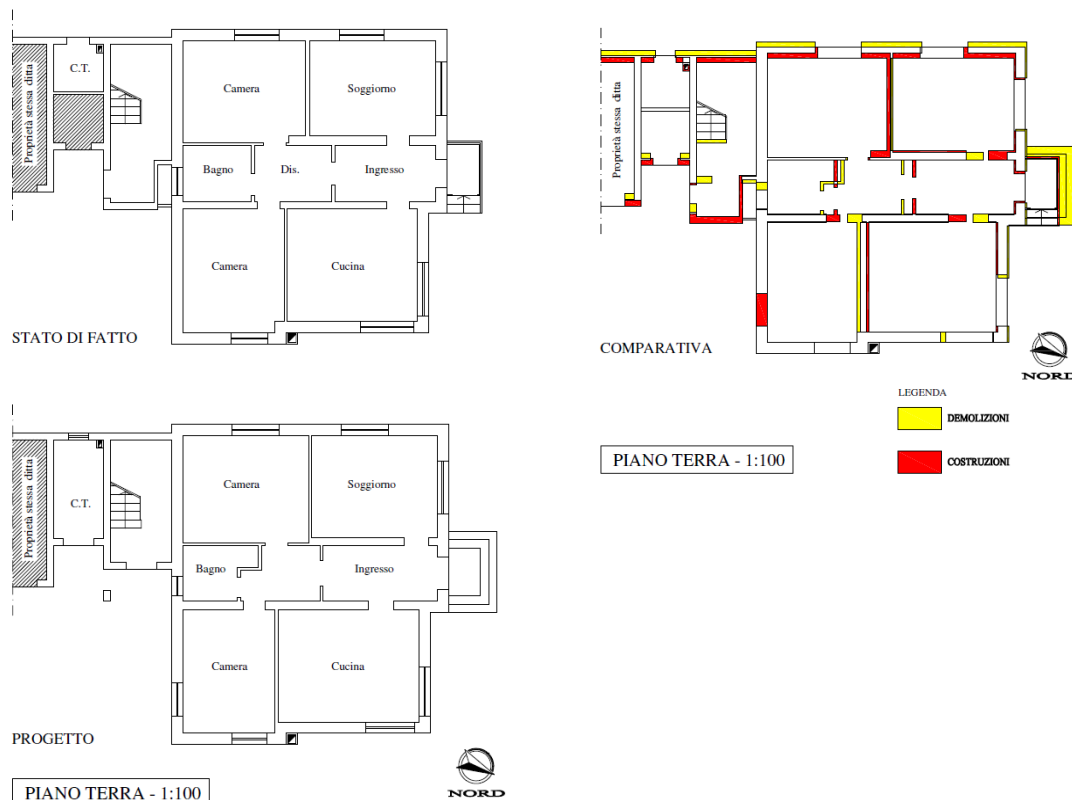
Planimetrie appartamento - stato di fatto – progetto – comparativa (fuori scala) – ([Allegato L.03.03](#))
